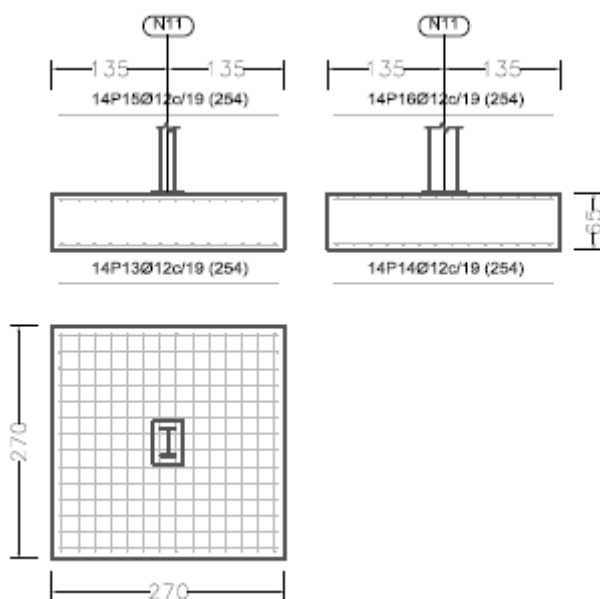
Ejemplo zapata cuadrada. Plano 4.1
